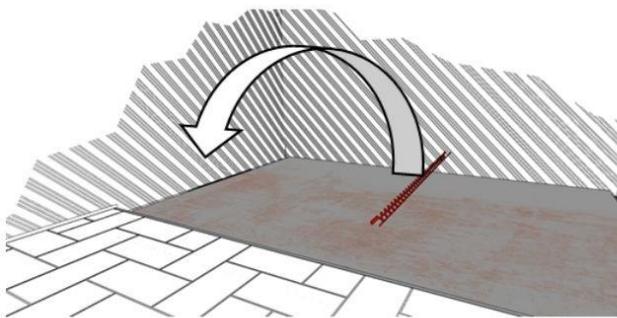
Retirar el listón de tolerancia, limpiar el canal de drenaje y colocar la rejilla de filtración.
